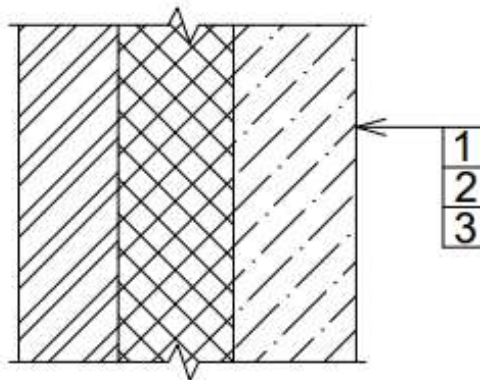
Конструкция каркасного варианта утепления: 1 – железобетон $\delta_1=0,16$ м;
